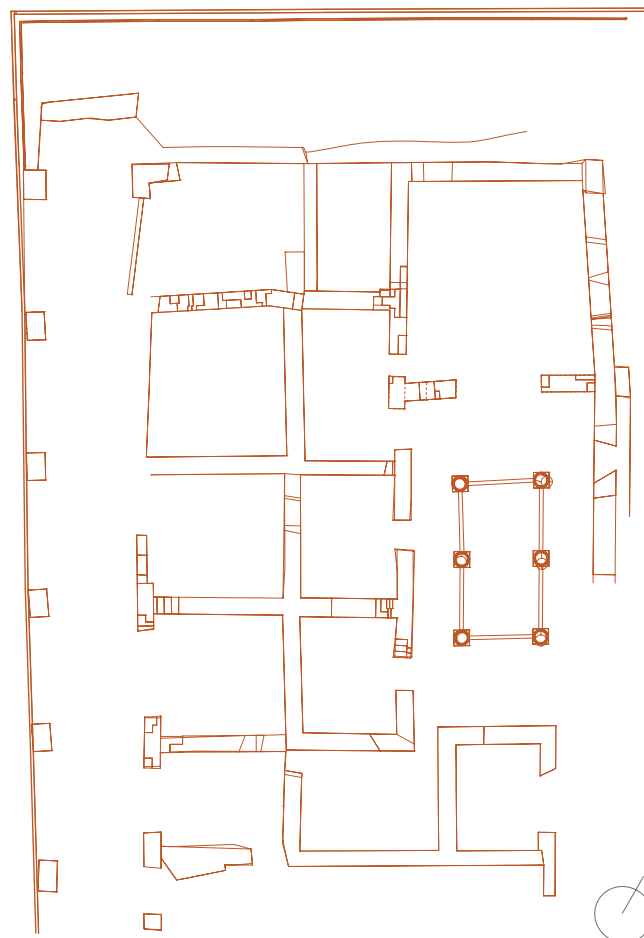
Plano del estado actual de la casa del Emparrado (fuente: R. Angulo, 2009. *Elaboración de las fichas diagnóstico de los bienes inmuebles del CAI*)
